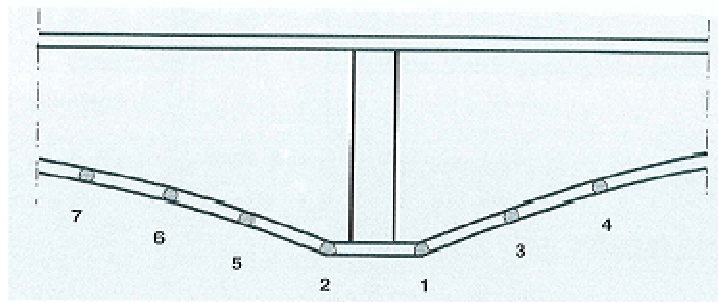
Cambrage d'une poutre de hauteur variable
